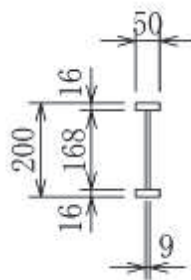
補助縦桁の断面形状 (単位: mm)
